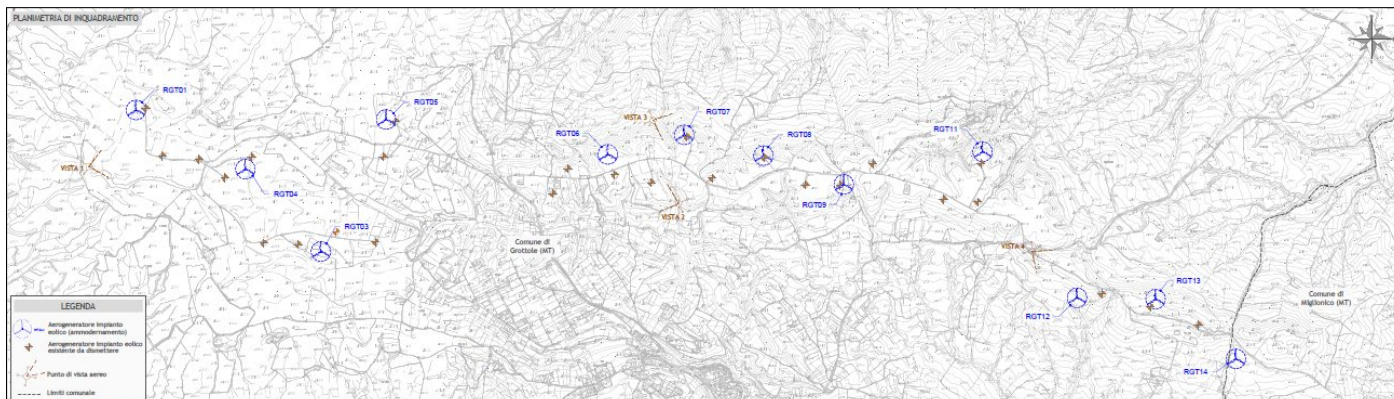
Stralcio della planimetria CTR con ubicazione punti di vista aerei per la documentazione fotografica attestante le condizioni del sito prima dell'intervento d'ammodernamento
